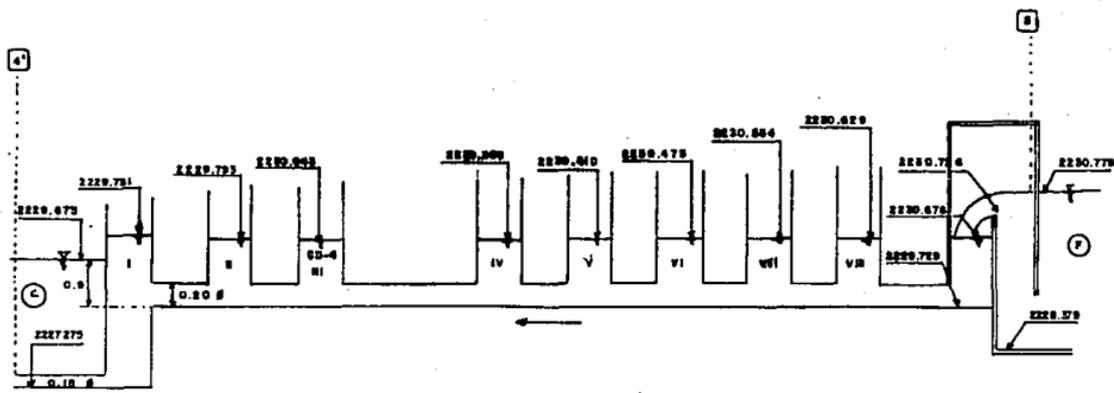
(a) TRAMO 4'-5 "PLANTA"
